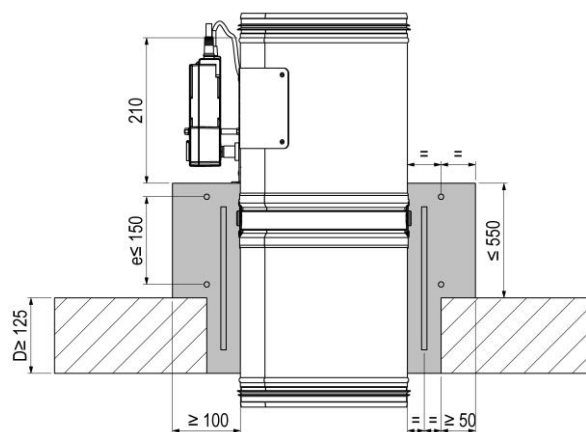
montaggio in soffitti massicci con zoccolo in calcestruzzo, sezione
